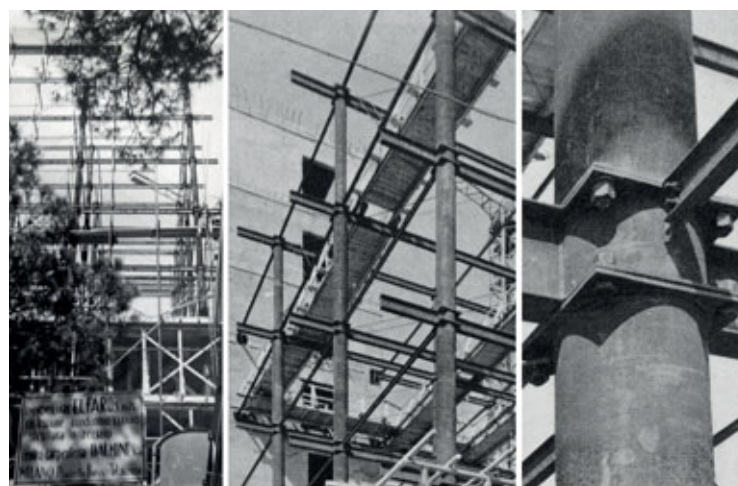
Progetto e costruzione dell'edificio "El Faro" (1958-1959): l'impiego di travi a sezione aperta e di colonne tubolari munite di flange (Fondazione Dalmine).
